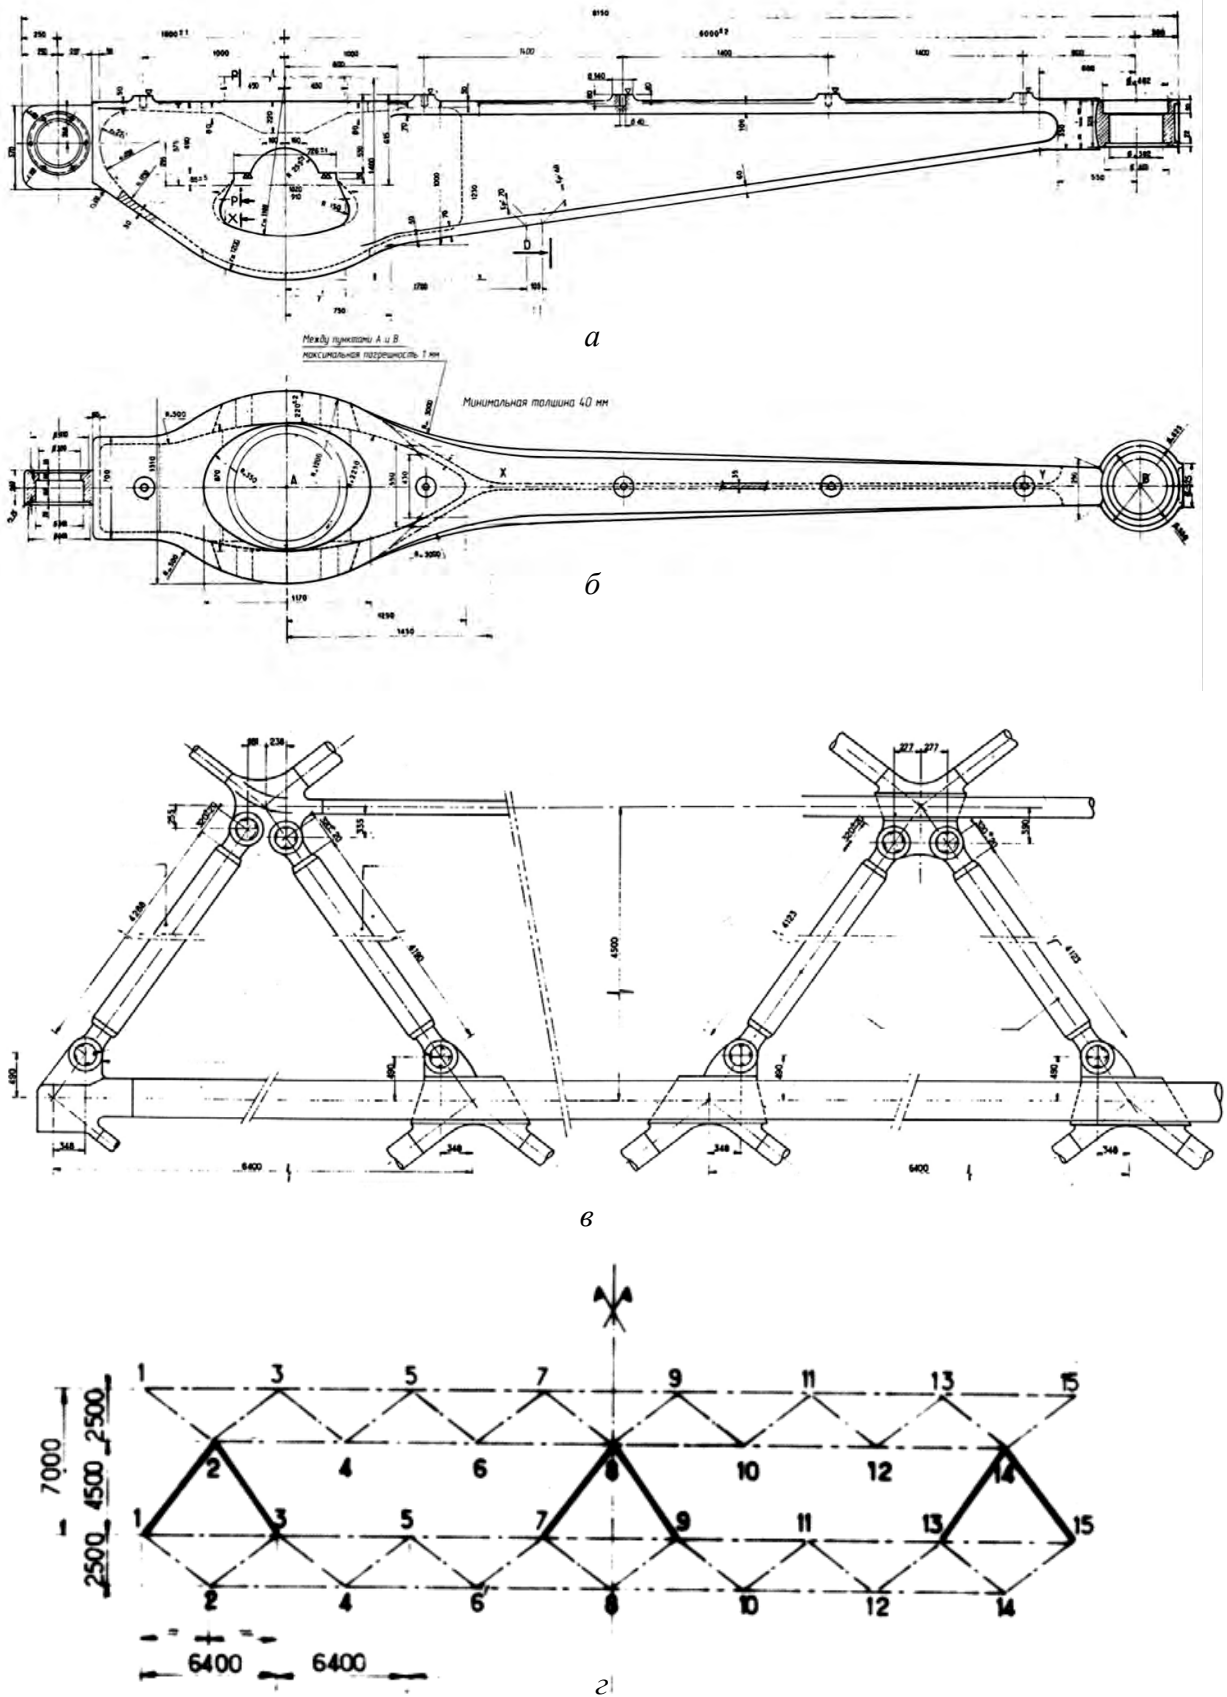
а – гербертта (вид спереди); б – гербертта (вид сверху); в – ветровые связи типа 2 и типа 3; г – схема размещения ветровых связей в поперечном сечении здания
